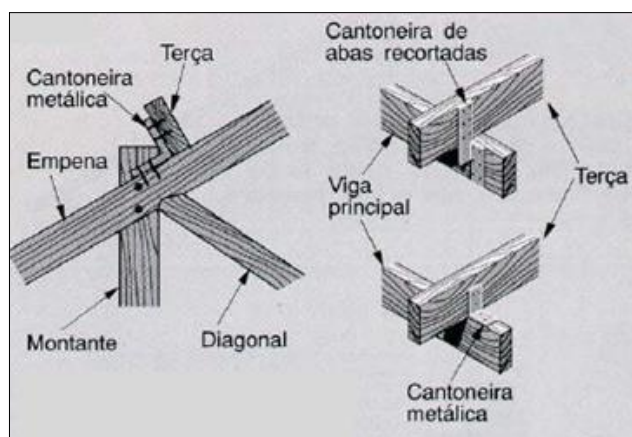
Apoio e fixação de terças de cantoneiras metálicas
